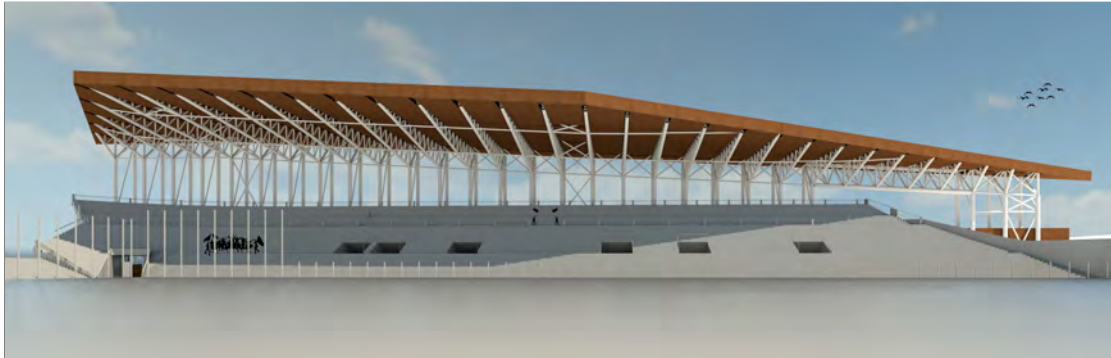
Soluzione strutturale 1 - Trave reticolare.
